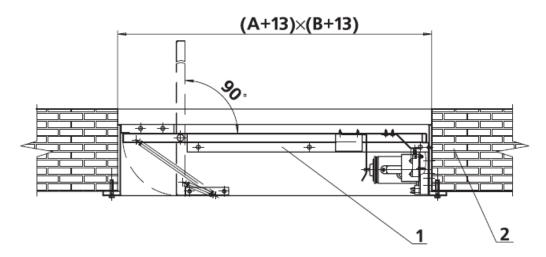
Монтаж дымового клапана КПД-4 производства ООО «Веза», присоединяемого к горизонтальному (потолочному) перекрытию: 1 – клапан; 2 – потолочное перекрытие
